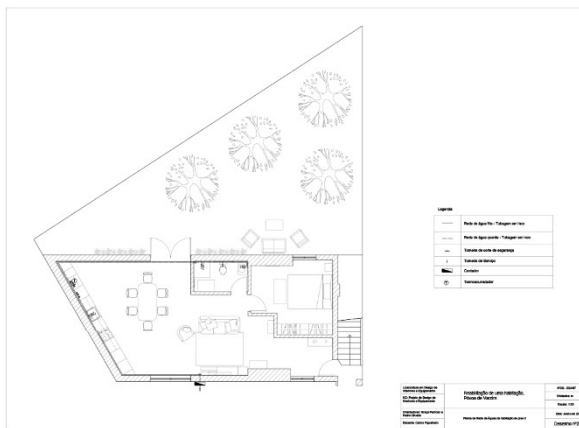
Planta de Rede de águas Habitação Piso 0. Fonte: Autor.
